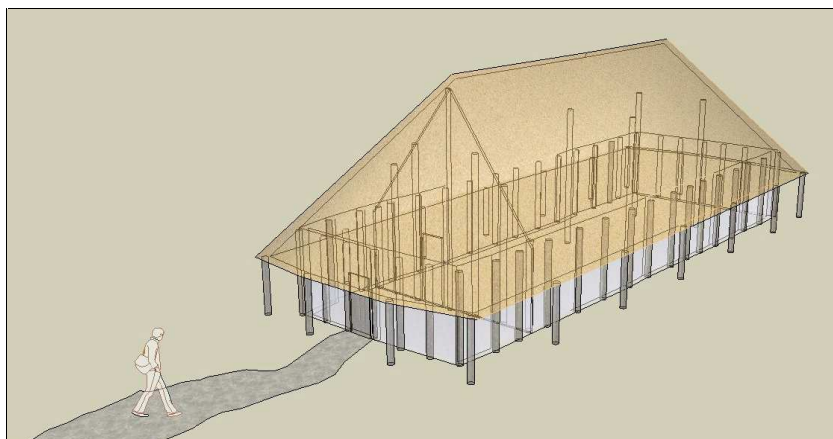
Rekonstruktionsskizze zu Haus 60.
